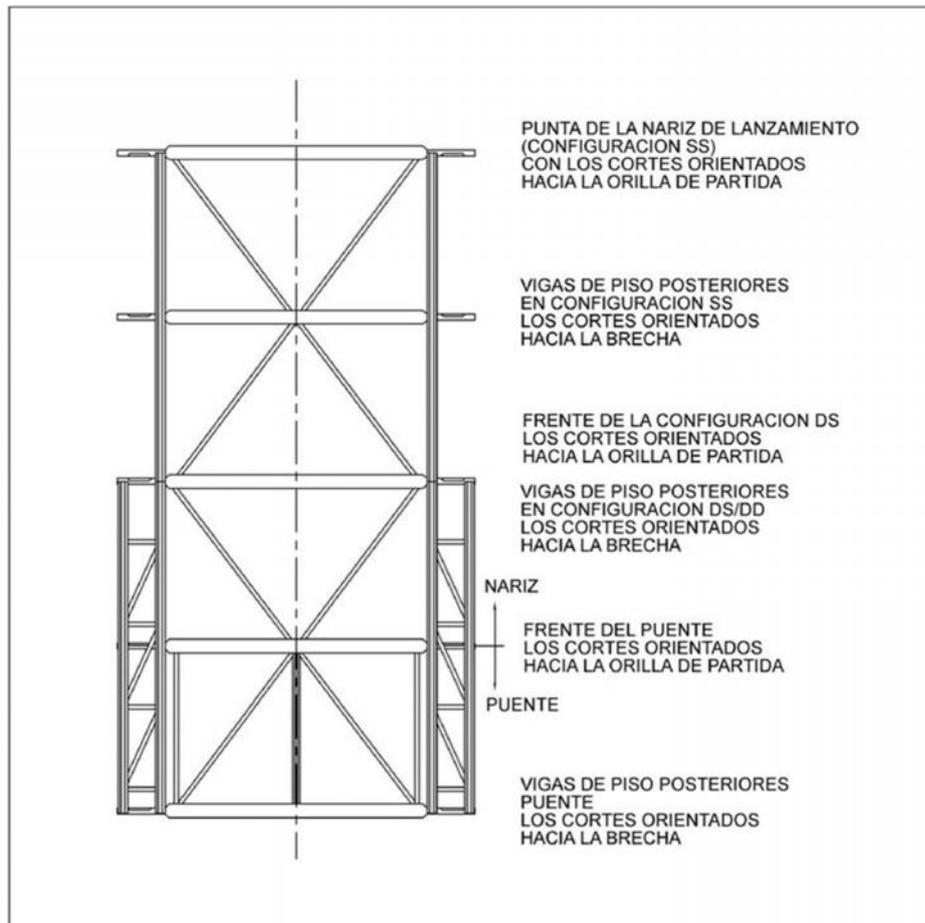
Esquema de instalación de vigas de piso en la nariz de lanzamiento
